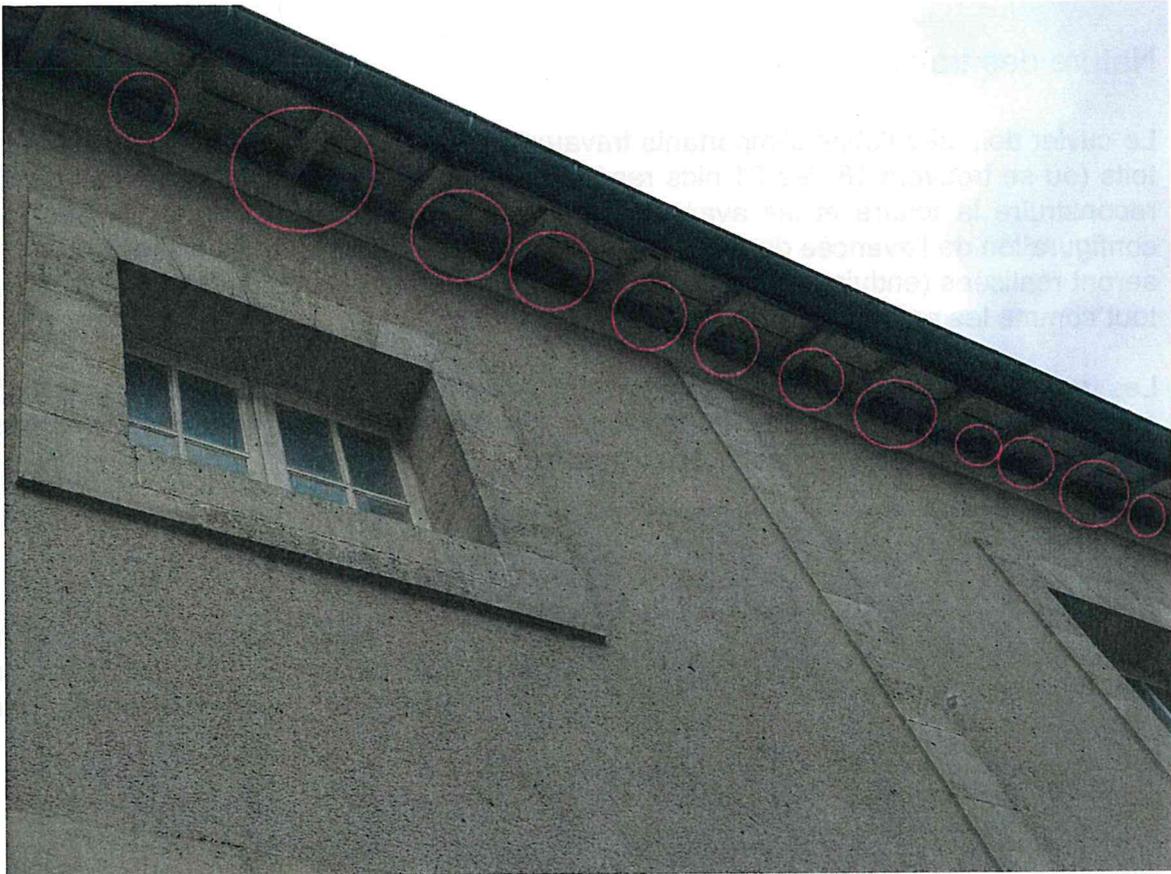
Nids d'hirondelles des fenêtres sous la toiture du cuvier (bâtiment B' sur les plans) ©LPO Aquitaine
